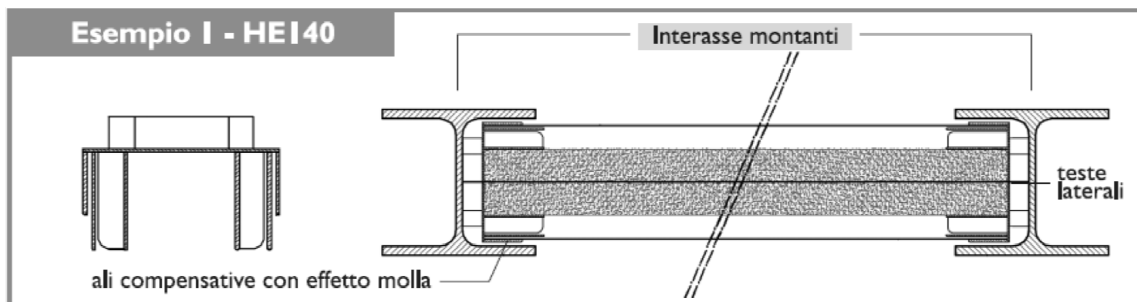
Schema di montaggio pannello fonoassorbente [www.alufon.it]
